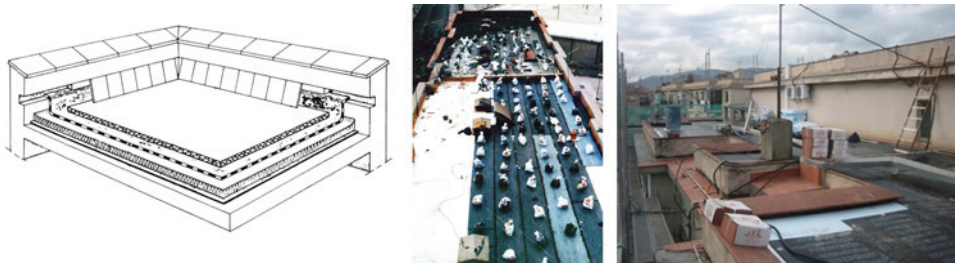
Refuerzo de aislamiento térmico en cubiertas planas disponiendo nueva lámina de estanqueidad y placas de material aislante.
